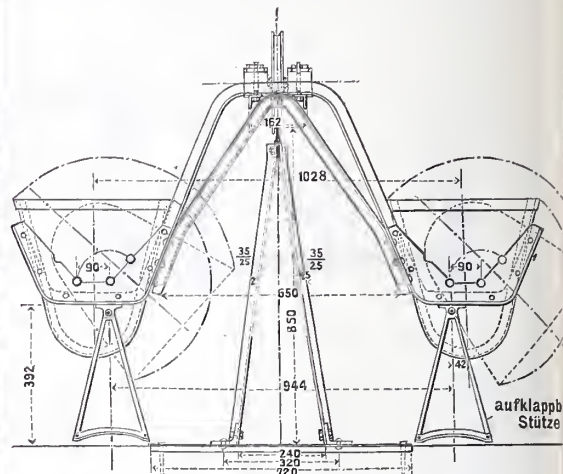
Stirnansicht des Oberbaues und der Wagen für die Lartigueschen Feld- bzw. Grubenbahnen.
